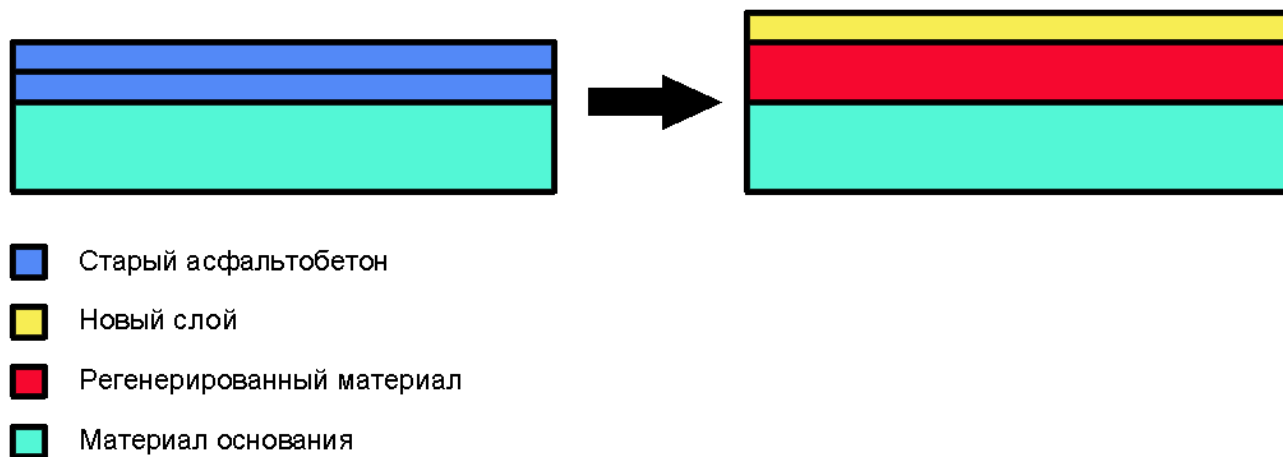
Схема проведения капитального ремонта дорожного асфальтобетонного покрытия с его восстановлением способами холодной регенерации
